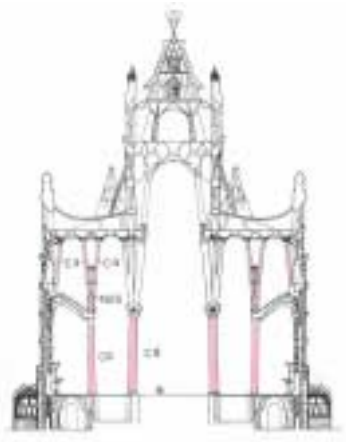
Corte transversal pela nave central a ser construída
